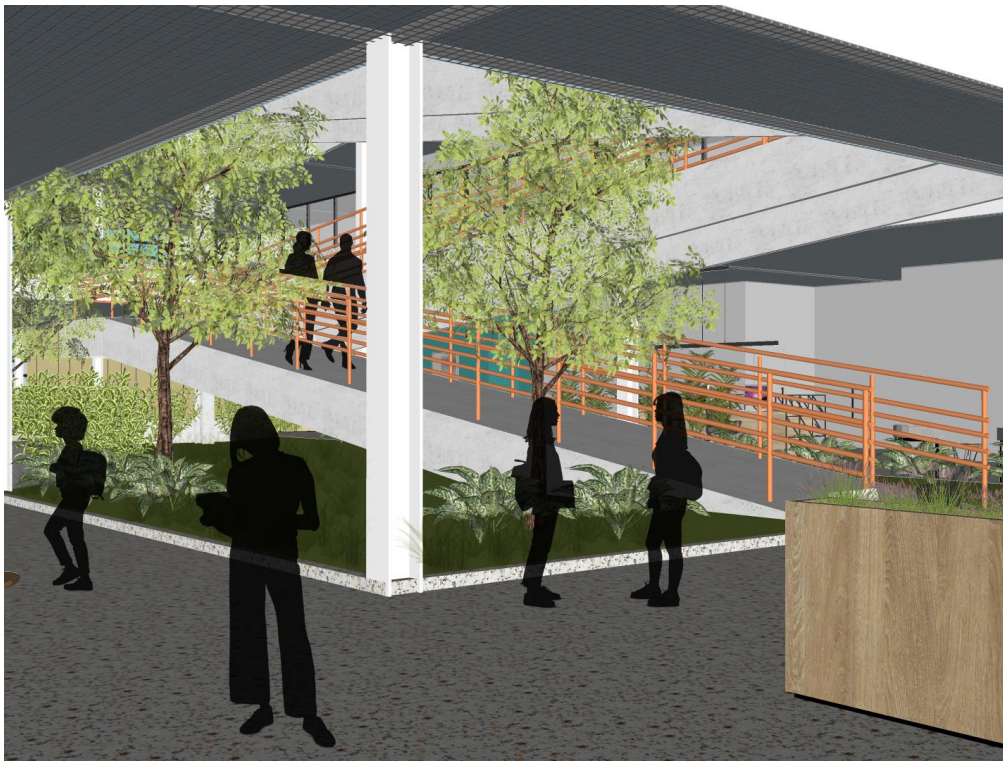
Vista Foyer e Rampa. Fonte: acervo da autora, 2021
